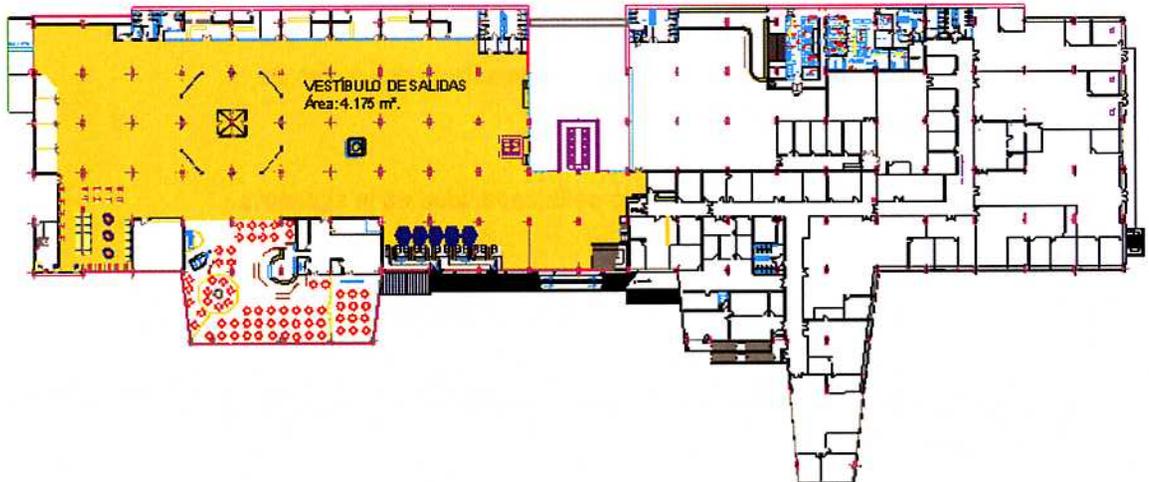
Instalaciones actuales. Planta alta T1
